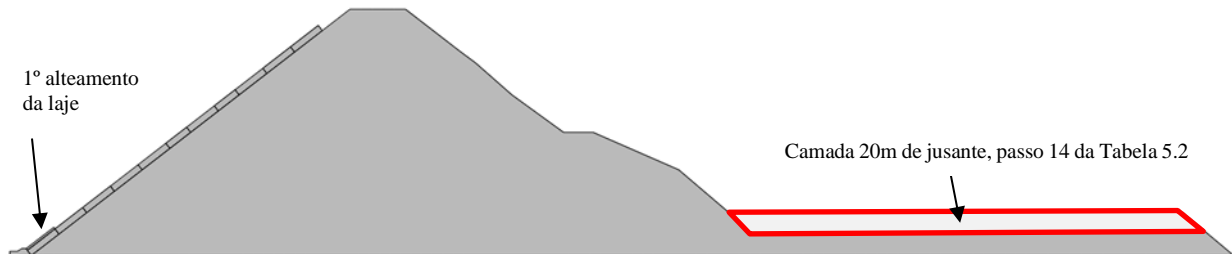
Primeiro alteamento da laje no modelo 2D.
